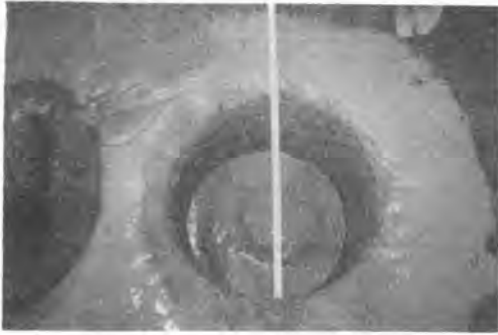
鋼管杭 (φ400) 打設跡 (対コンクリート)
